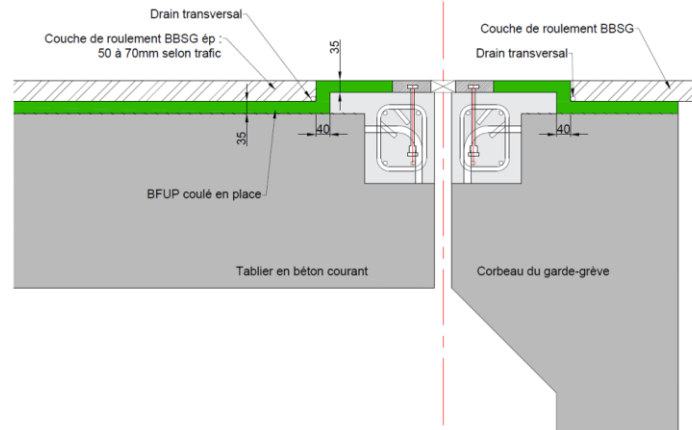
Disposition recommandée au niveau d'un solin de joint de chaussée (par exemple dans le cas d'une intervention sur l'existant pour lequel le solin est sain)
